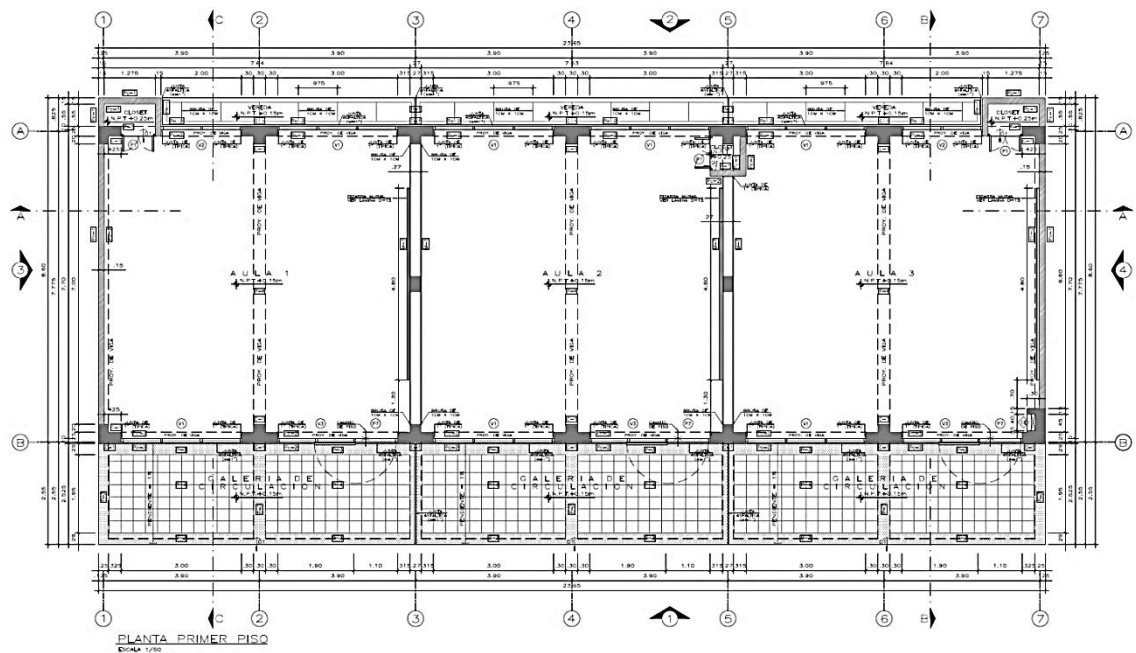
Planta primer nivel MODULO 780-COSTA 3A 3A
